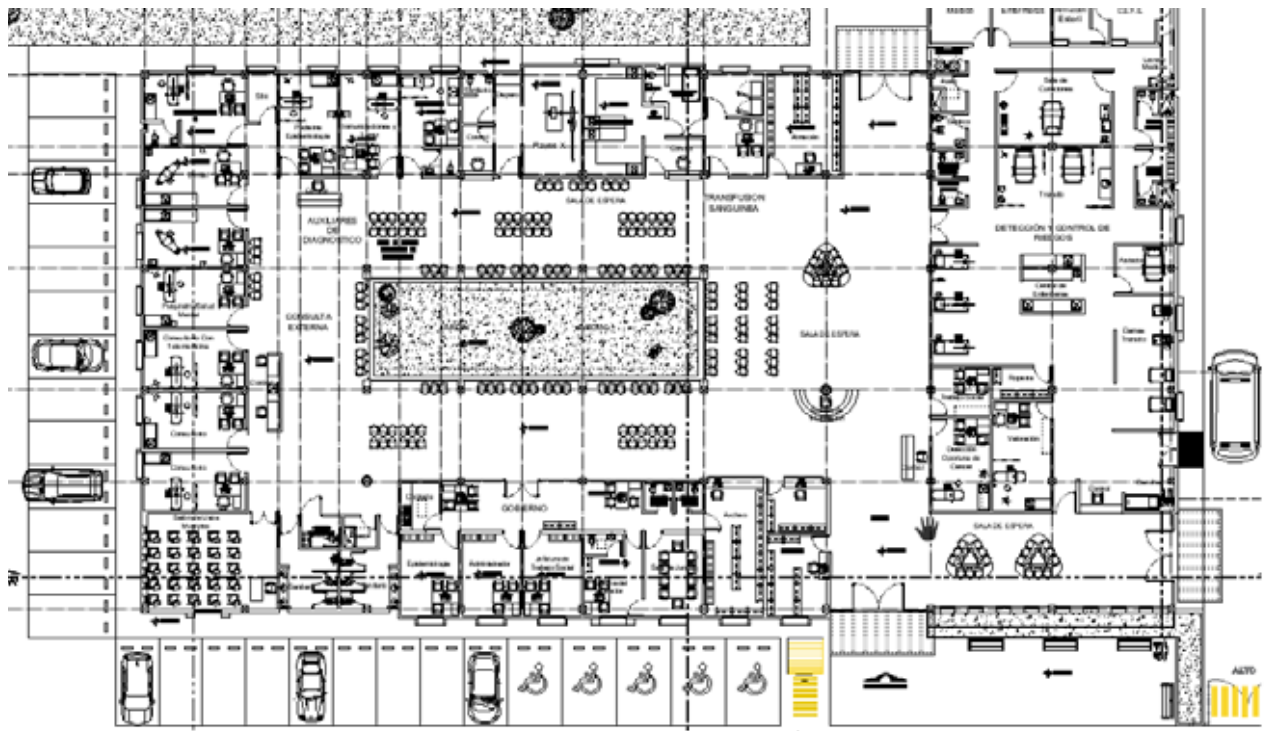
Planta de arquitectónica Cuitzeo. Fuente: secretaria de Salud. 2020.
